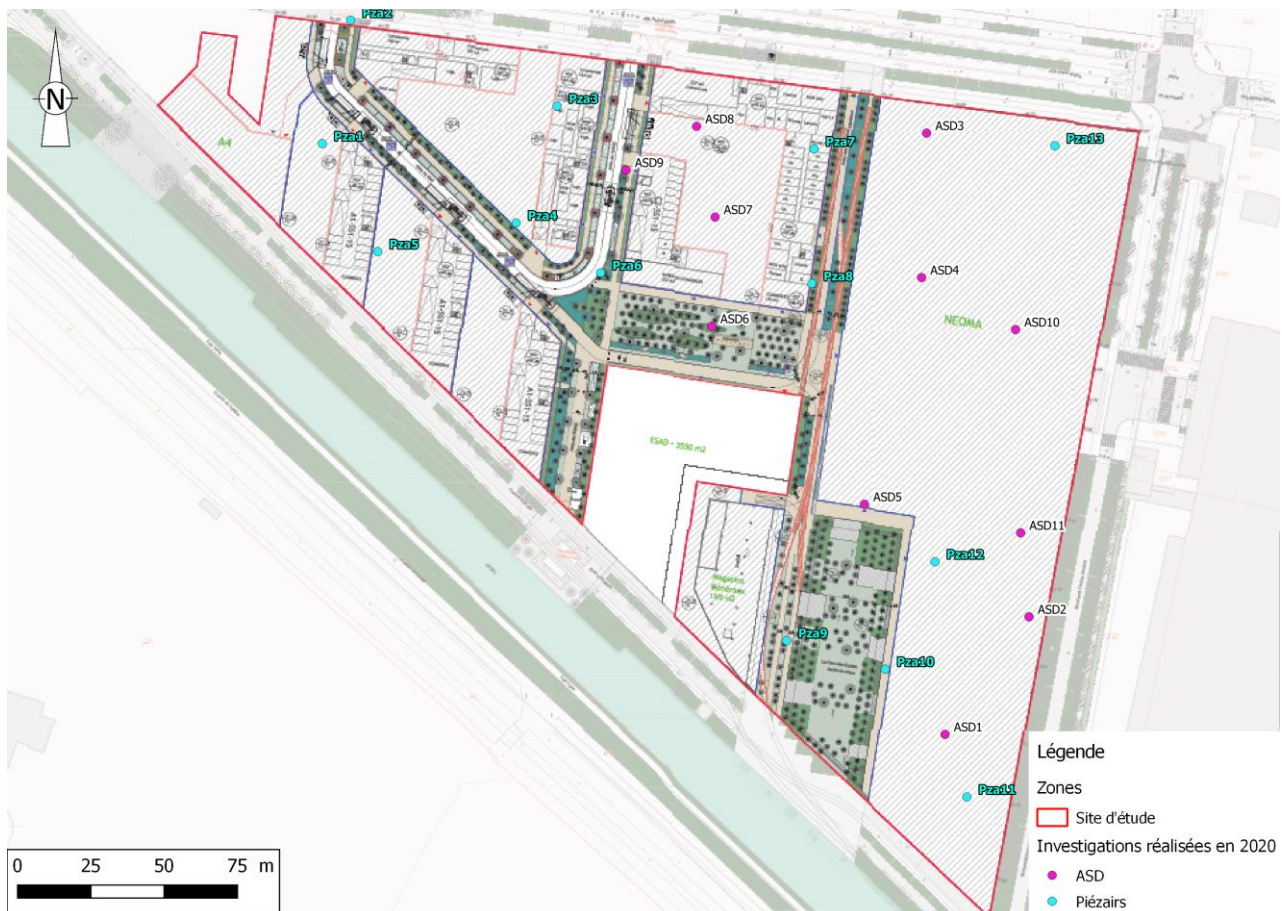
Prélèvements des airs sous dalle et gaz des sols localisés sur le plan du projet (plan du 10/05/2021)
